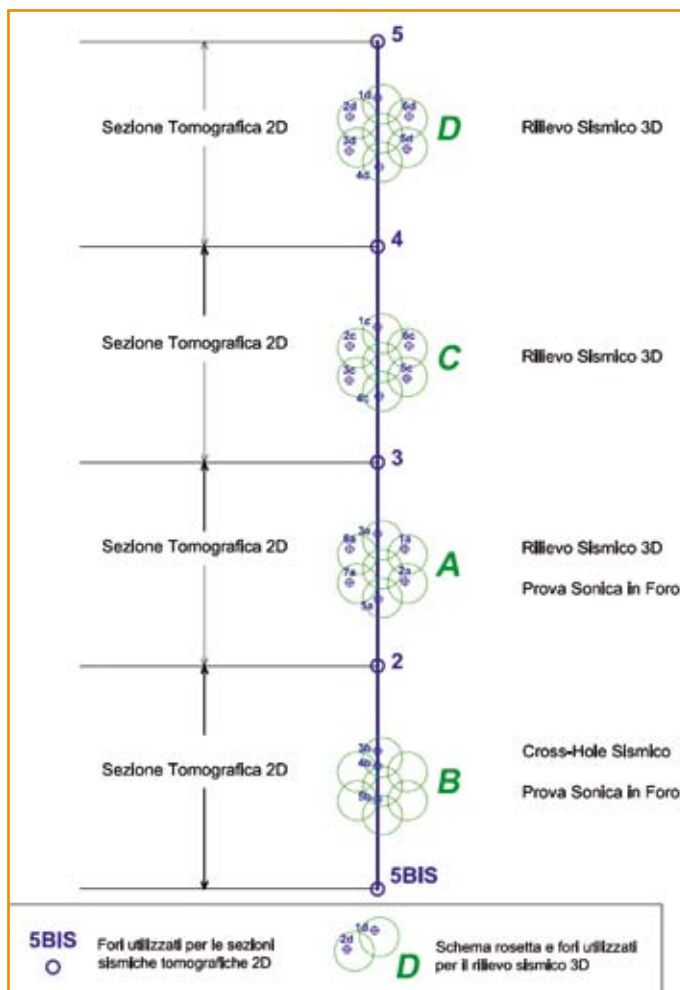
Schema planimetrico delle indagini geofisiche eseguite
